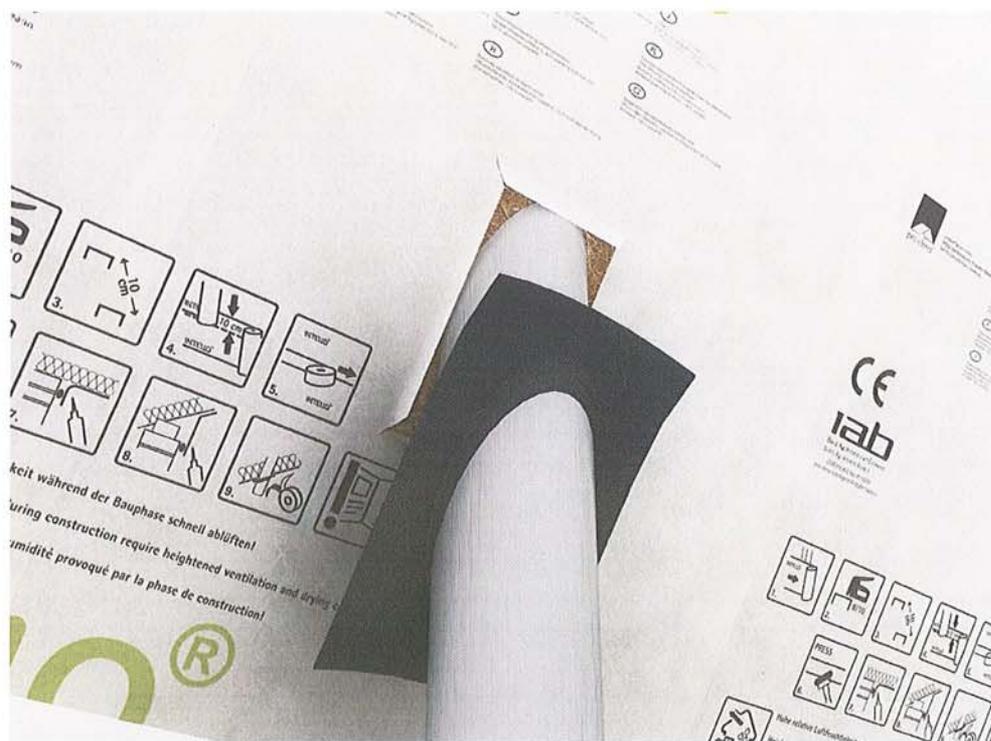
La manchette ROFLEX est à glisser sur le conduit
